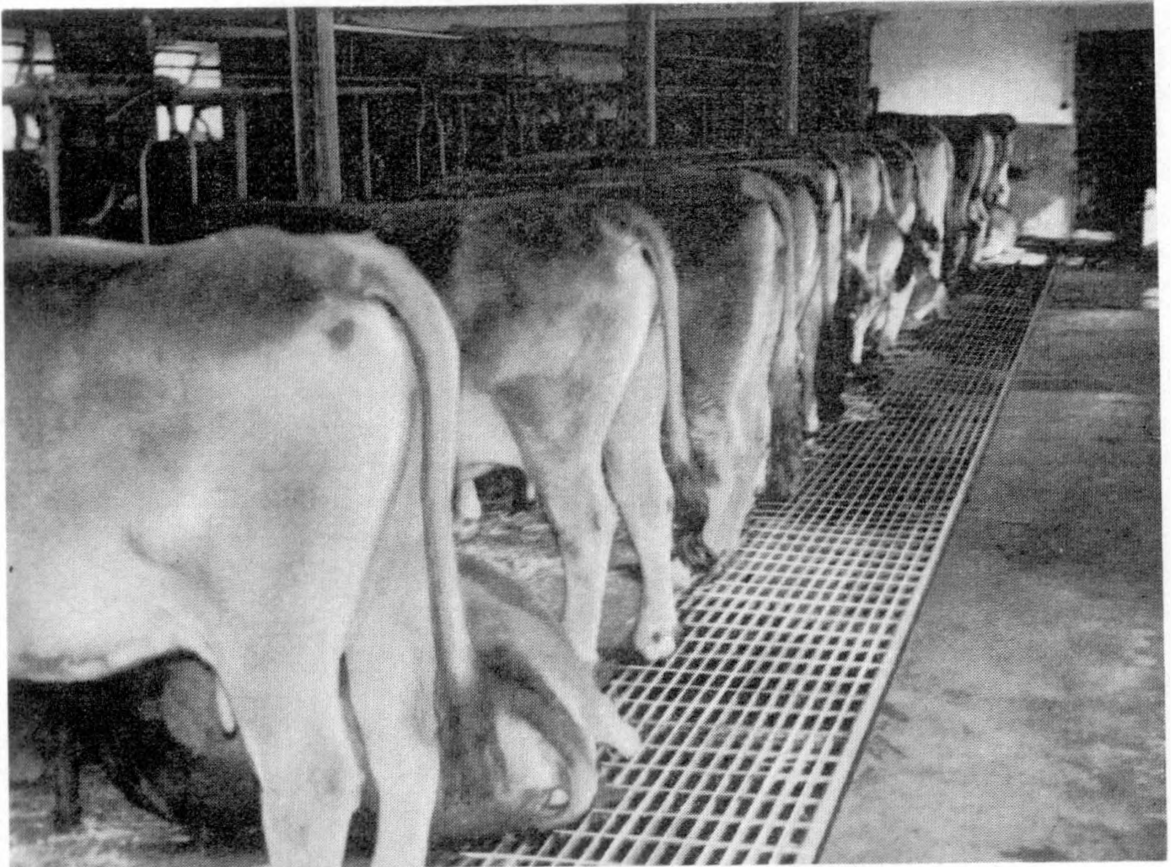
Kotroste, mit der Standfläche plangleich verlegt
